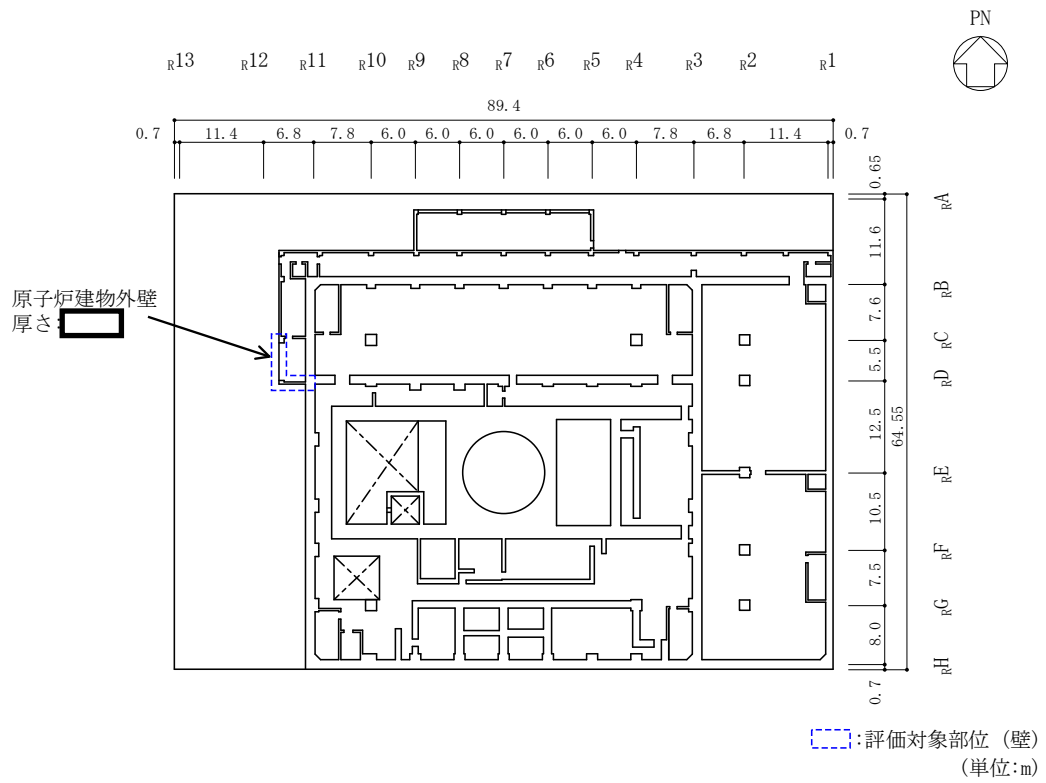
(1) 原子炉建物の概略平面図 (EL 34.8m*)
